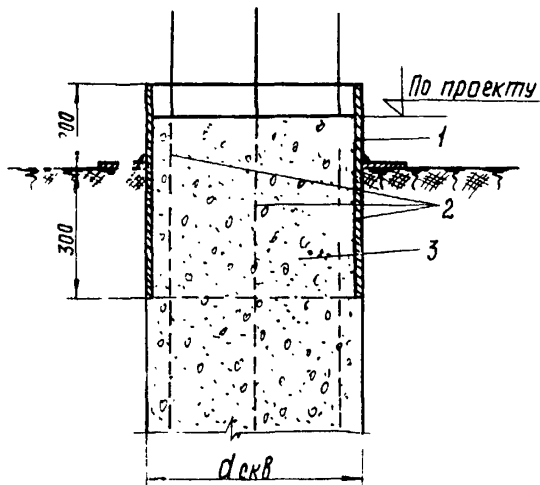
Формование головы свай с помощью инвентарной опалубки:
